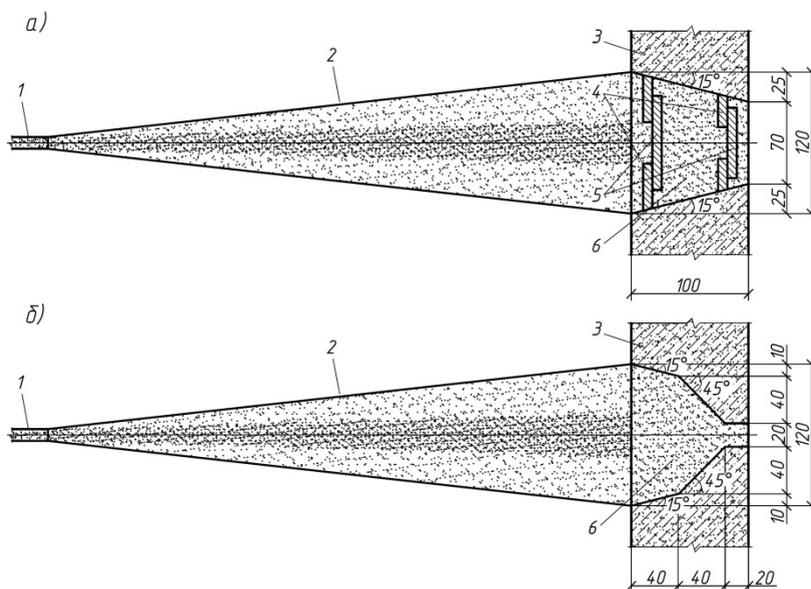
Формы стыков несъемной железобетонной опалубки при их замоноличивании способом мокрого торкретирования: а) стык армированный; б) стык неармированный; 1 - сопло; 2 - струя торкрета; 3 - тонкостенный железобетонный элемент несъемной опалубки; 4 - арматурные выпуски; 5 - накладки для сварки арматурных выпусков; 6 - полость стыка тонкостенных железобетонных элементов, которая заполнена мелкозернистым бетоном
